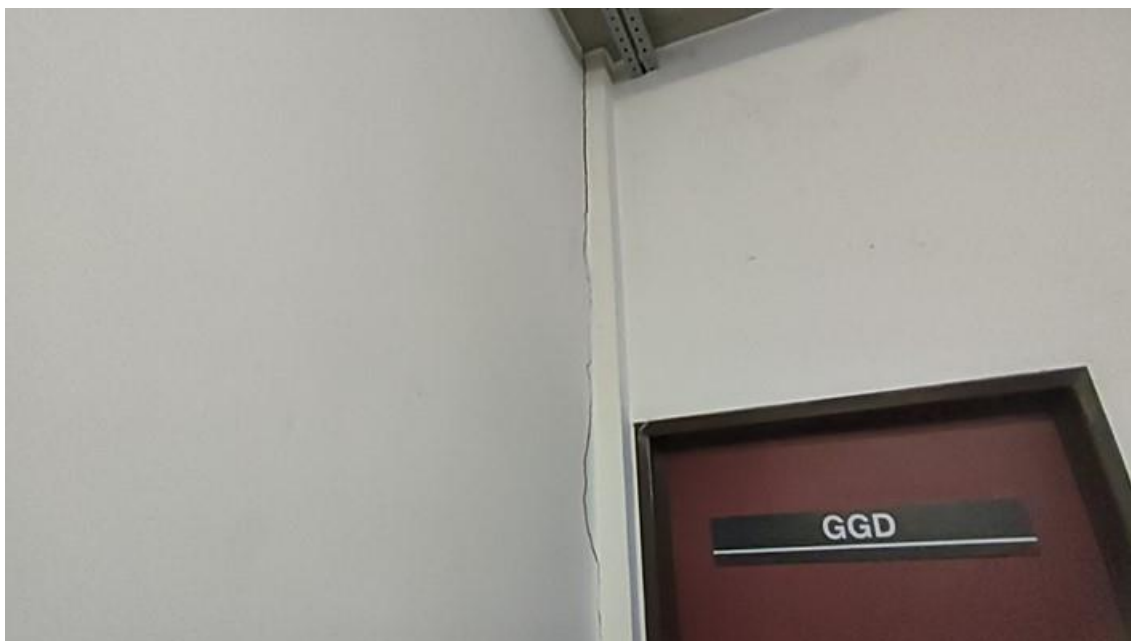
Fissura na parede da Subestação Auxiliar
